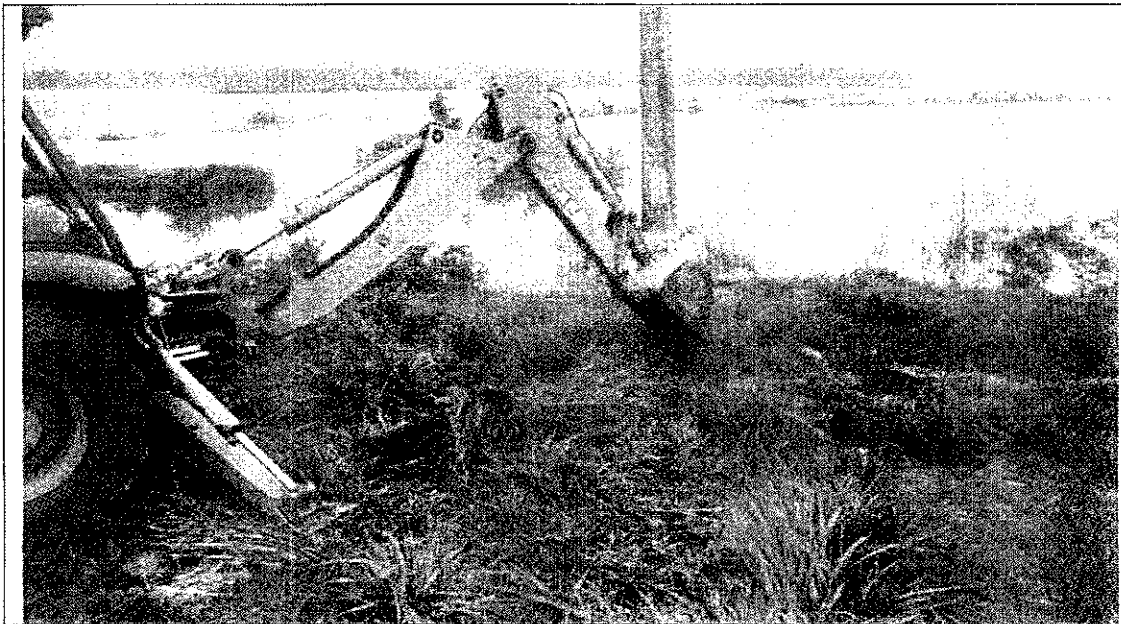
DURANTE - Escavação na lateral da fundação do poste
